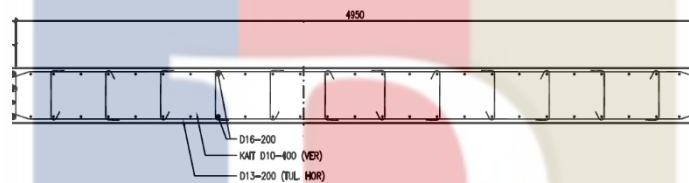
Detail Penulangan *Shear Wall* 1
